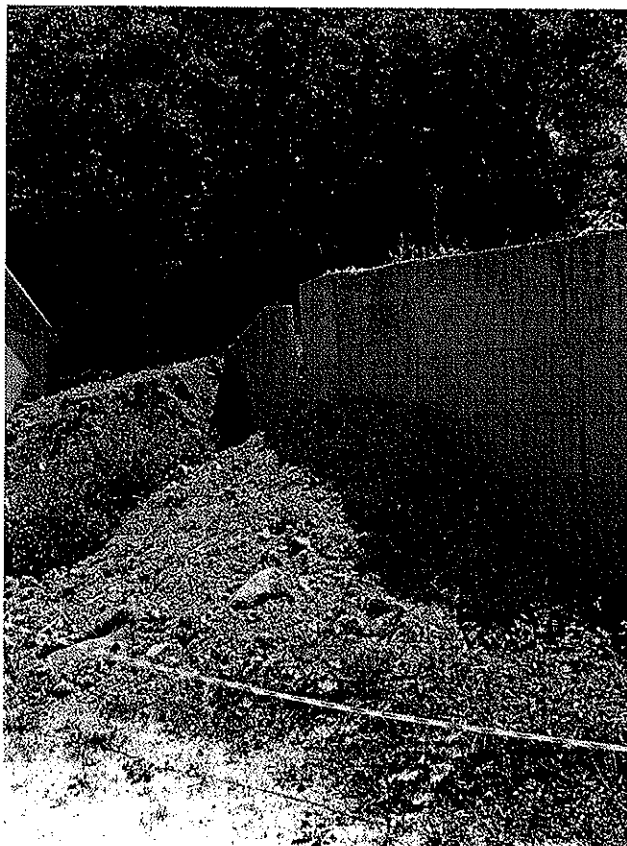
E' visibile sullo sfondo un altro tratto di muro che ha subito un evidente movimento di rotazione e traslazione in avanti (luglio 2010)
